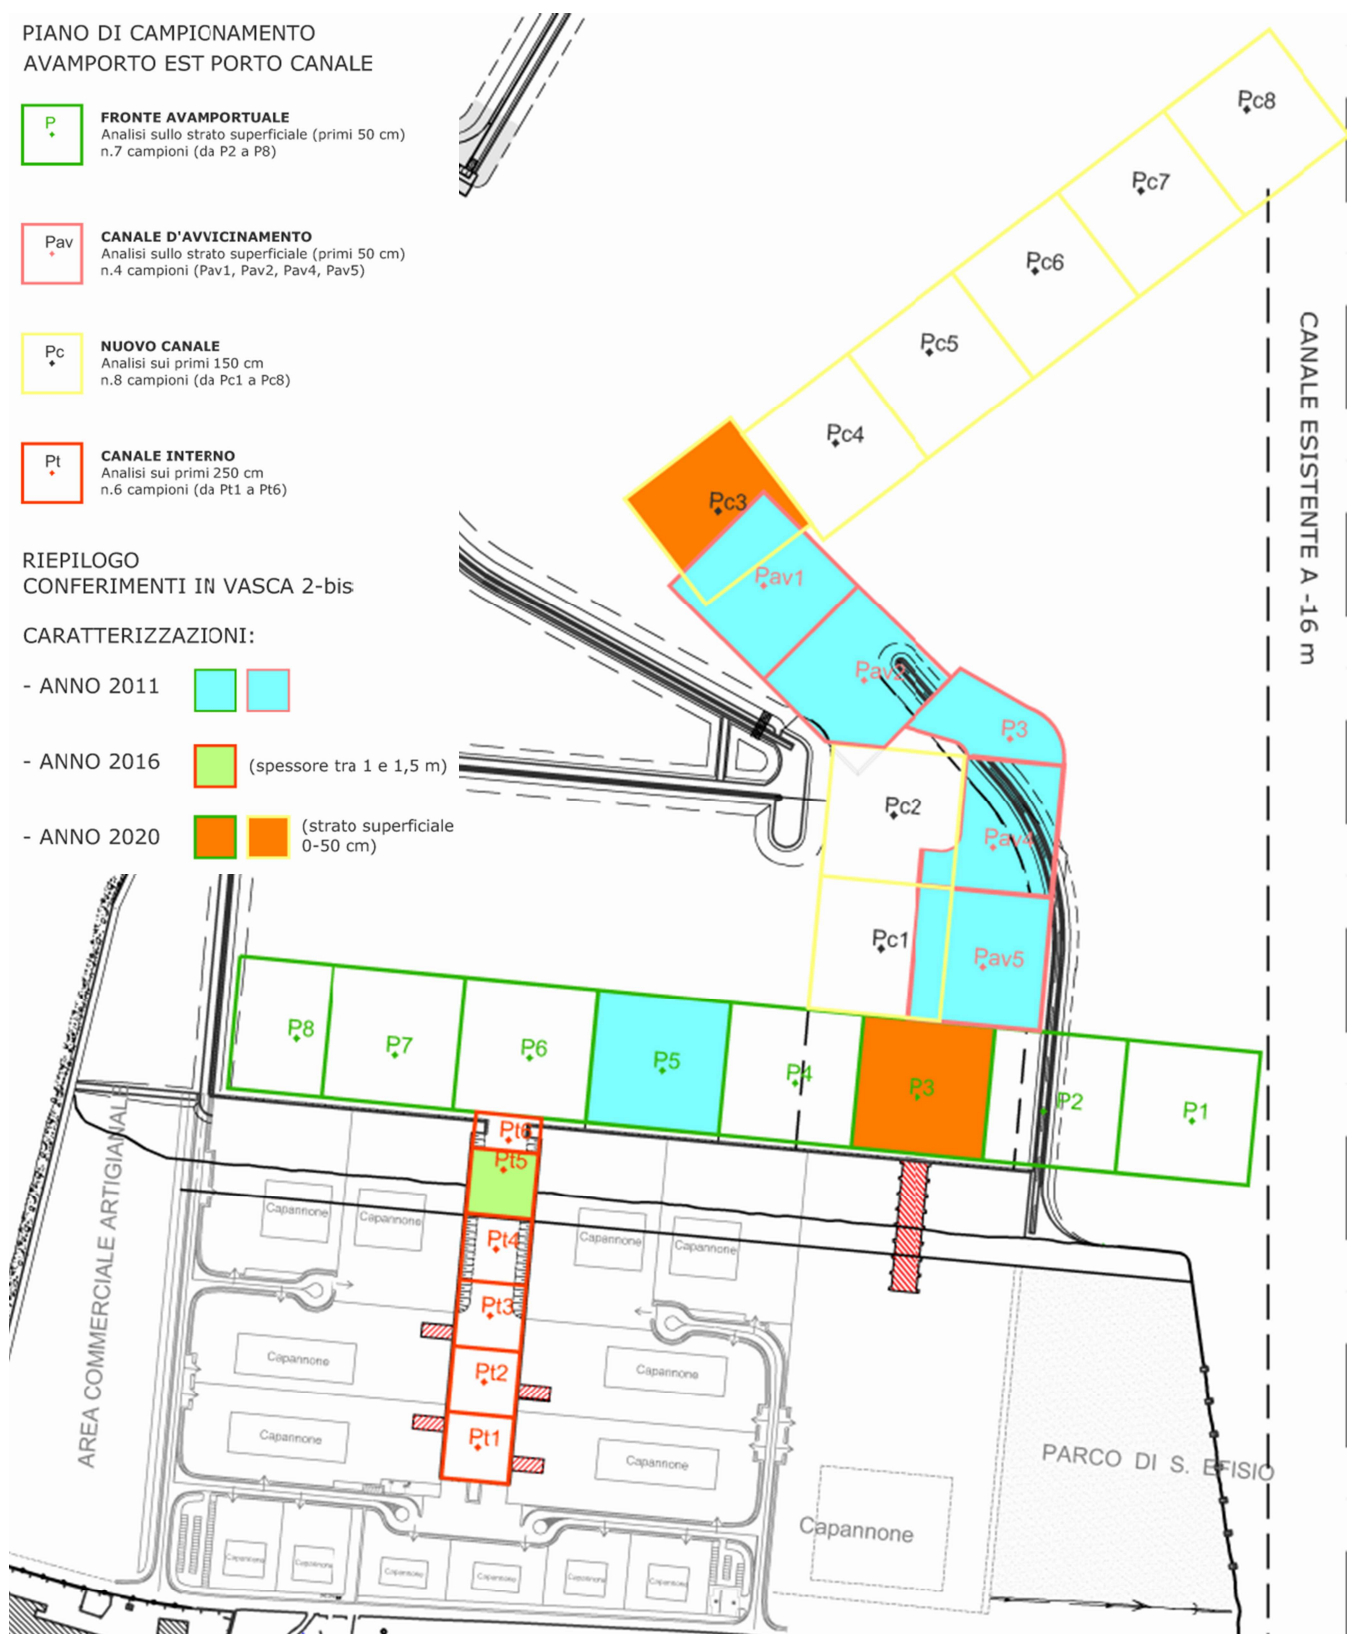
Planimetria riepilogativa allegata alla Nota del 13/01/2021 Prot. n°717
